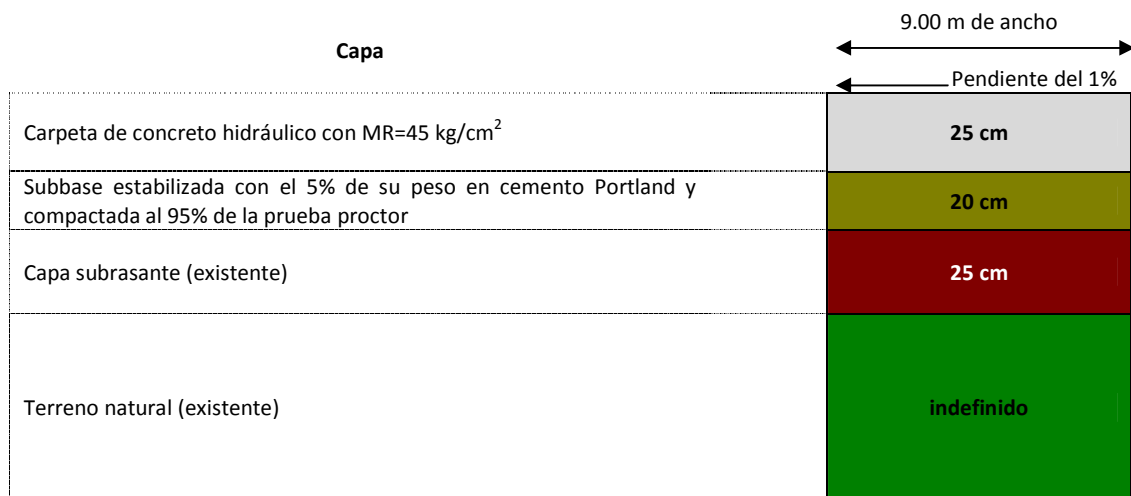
Sección transversal para el pavimento de los dos cuerpos laterales.
